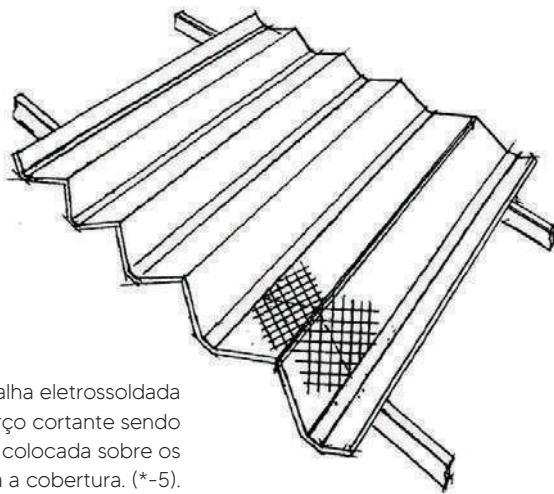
Malha eletrossoldada extra para esforço cortante sendo necessário ser colocada sobre os apoios em toda a cobertura. (*-5).
